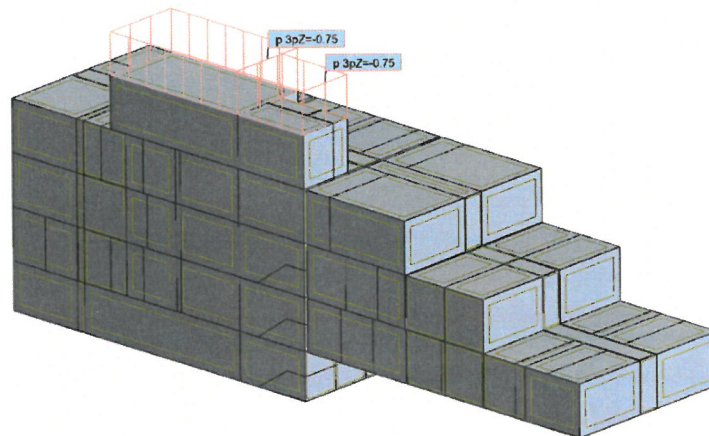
Przypadek obciążenia użytkowego od dachu ekstensywnego
